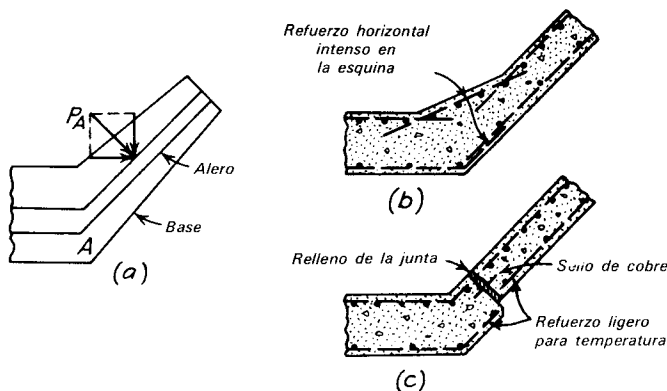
a*) Detalle en la unión del muro frontal y el alero de un estribo. *b*) Refuerzo necesario para construcción monolítica. *c*) Junta necesaria para funcionamiento independiente.
